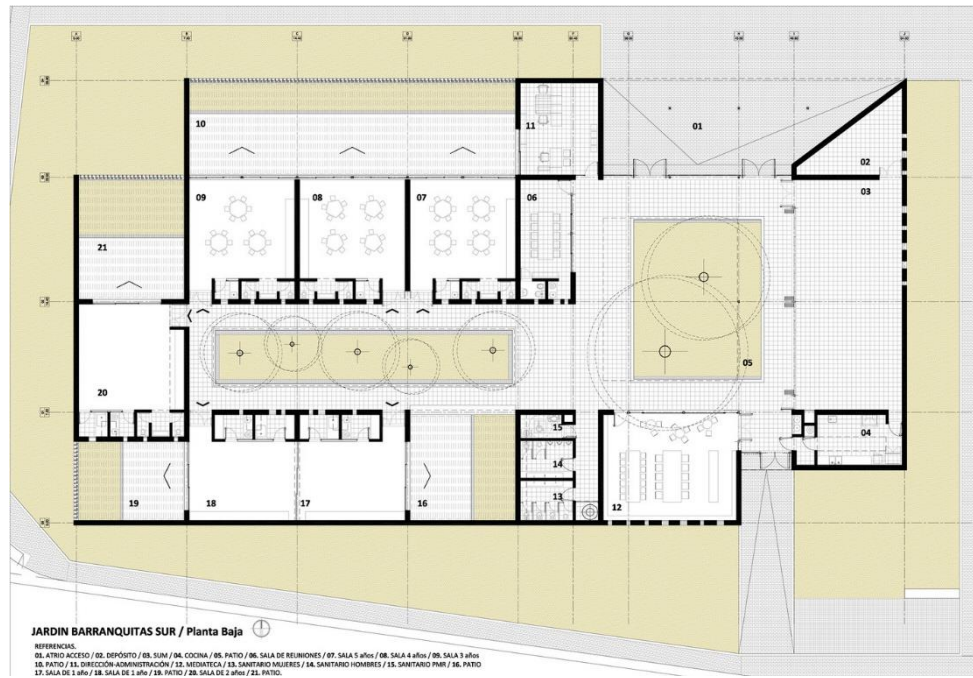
Planta baja de Jardín Municipal Barranquitas Sur, Santa Fe, Argentina.
